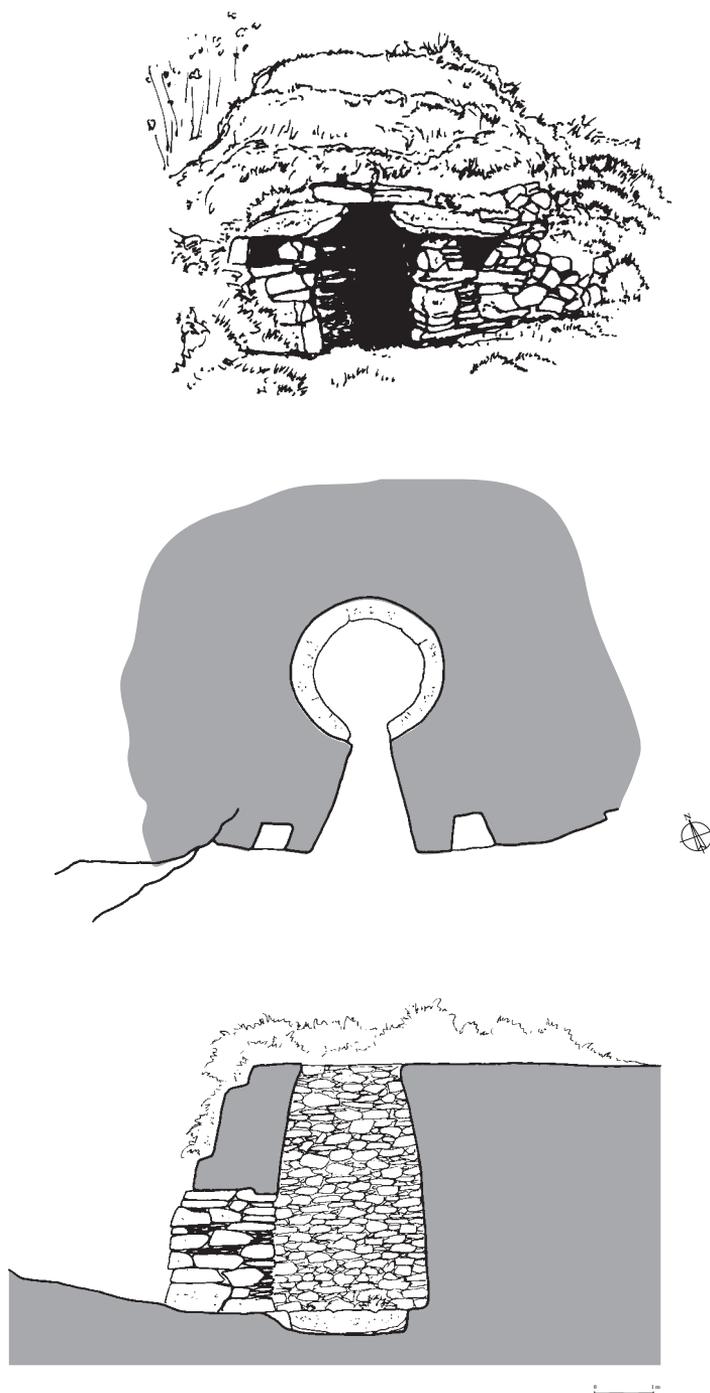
Alzado, planta y sección del calero de Castandiel (Navalgas).
